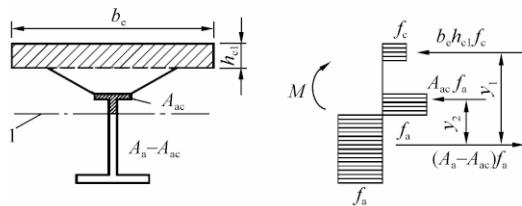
中和轴在钢梁内时的组合梁截面及应力图形
